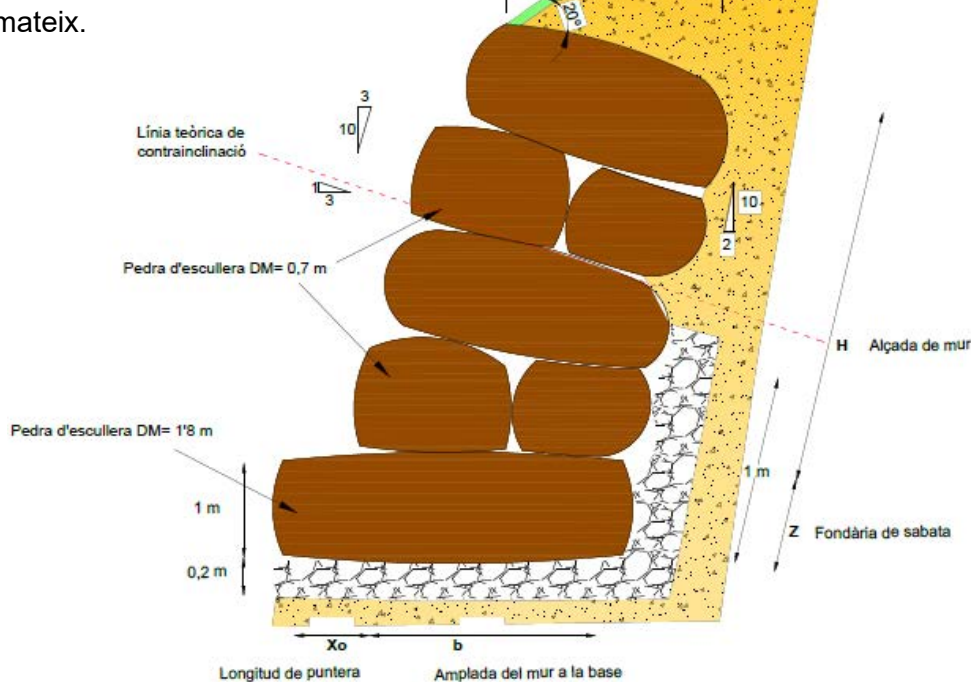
Plànol del perfil del dic de sosteniment a construir.
